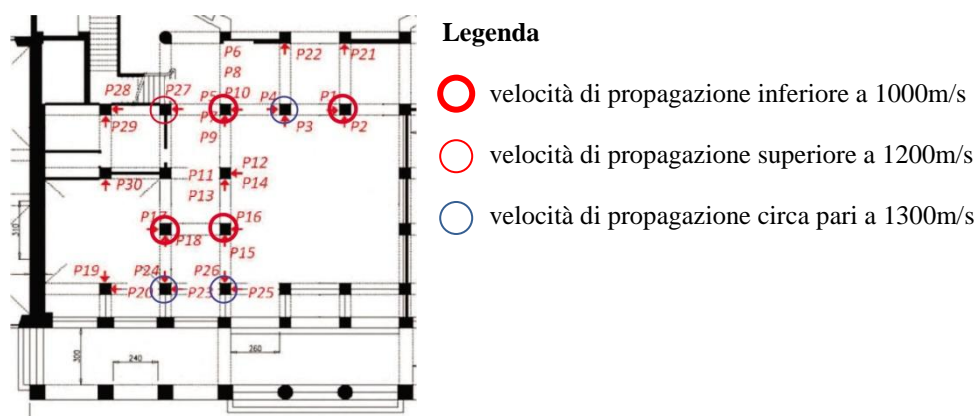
Localizzazione dei pilastri con minore velocità di propagazione del suono piano terra
